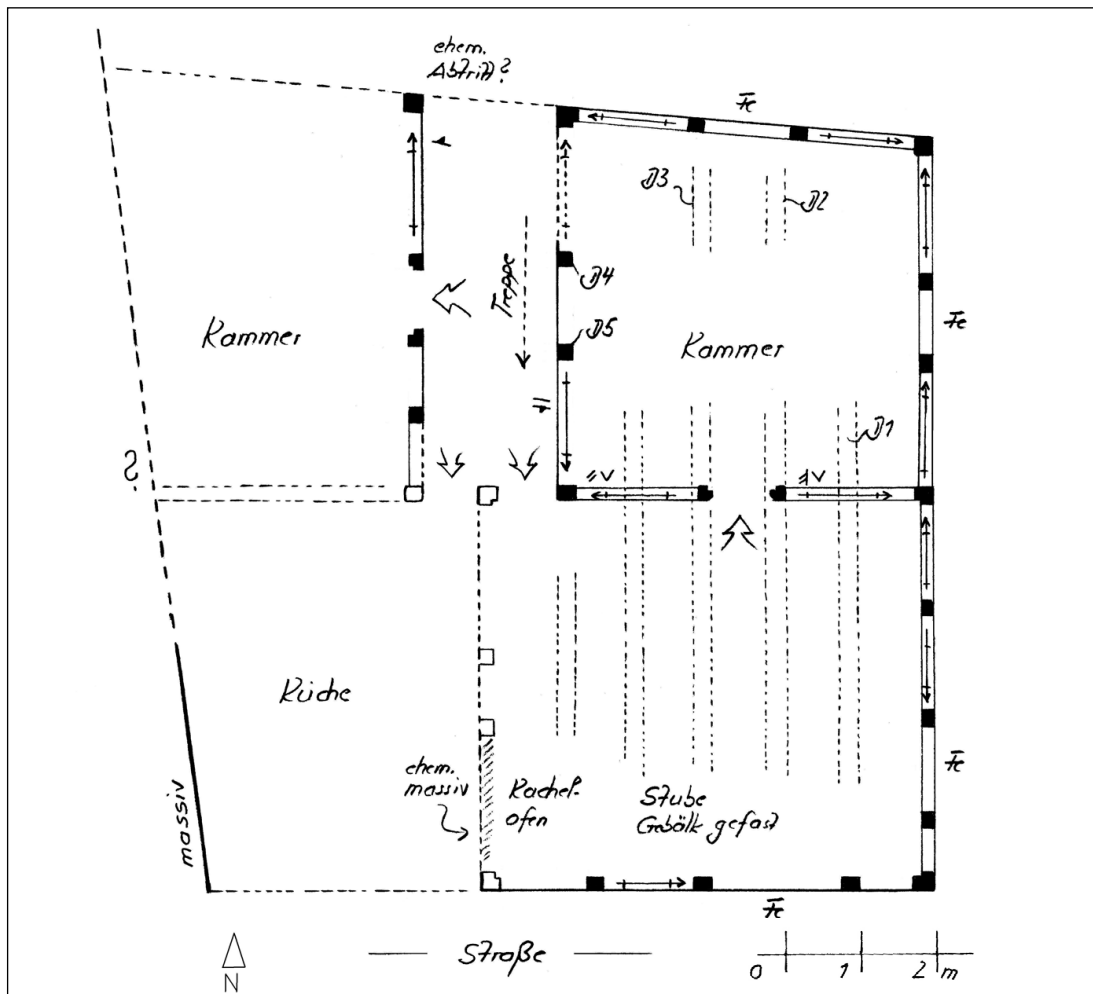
Jägersgasse 14, Grundriss 1. Obergeschoss, 1698 (d).
